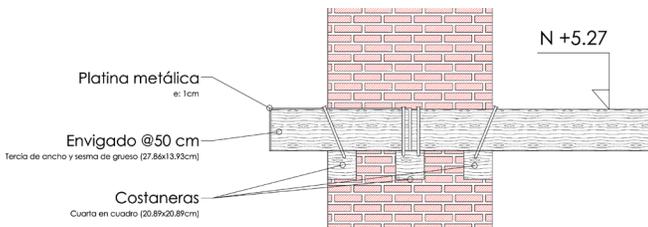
Detalle unión muro-entrepiso. Elaboración propia en base a Montandón, 1980
